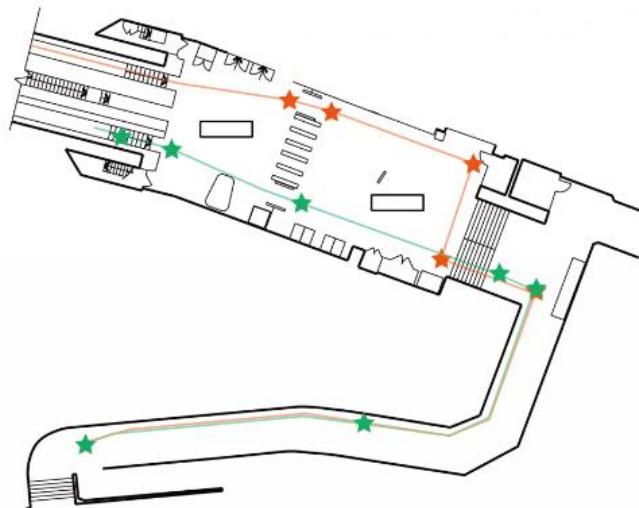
Posición de las balizas en el metro de Londres para la aplicación Wayfindr.
